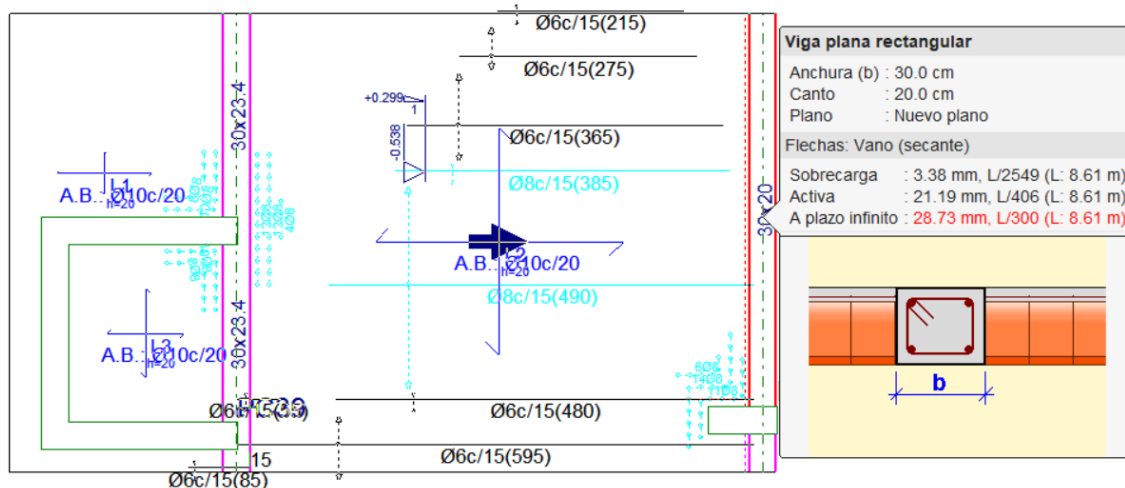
Flechas en Vigas, Planta Castillete, Modulo C
